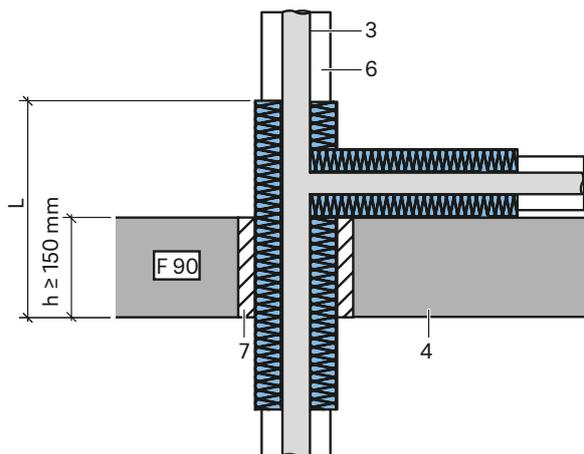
Installation dans un plafond massif avec dérivation
